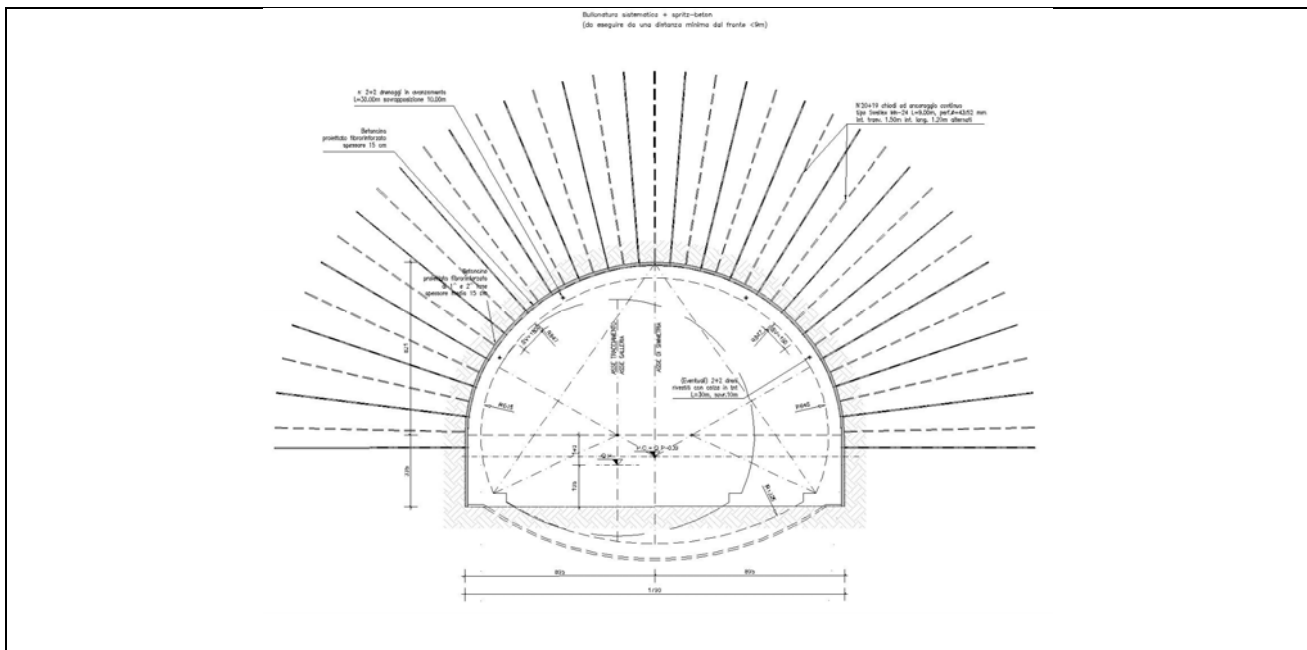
Sezione di scavo tipo GD-PS-A1 – PIAZZOLA DI SOSTA - Sezione trasversale
